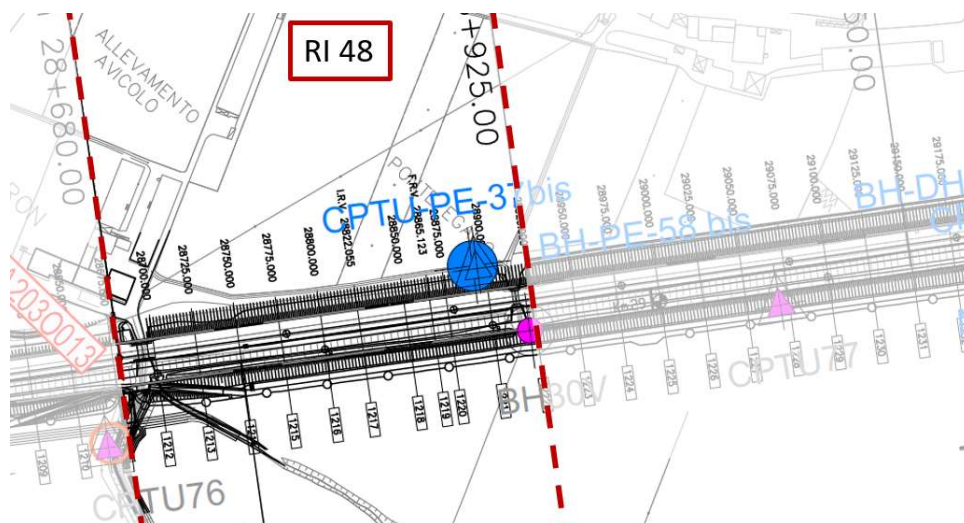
Planimetria Rilevato RI48, estratto dalla Planimetria Generale (Doc. Rif. [3])
